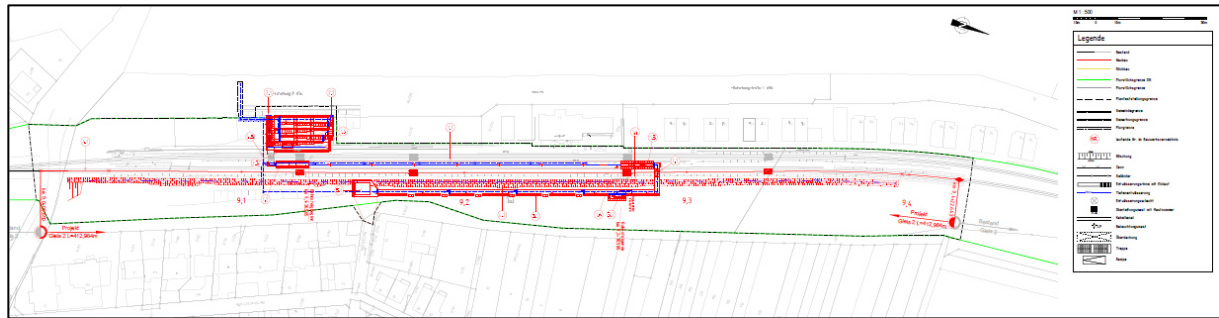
Lageplan Variante 1b (ILF CONSULTING ENGINEERS AUSTRIA GMBH 2020).
